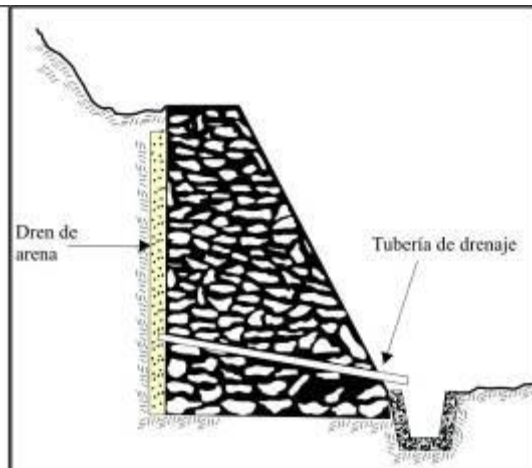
Muros de gravedad de piedra argamasada (tomado de INGEMMET, 2000).
